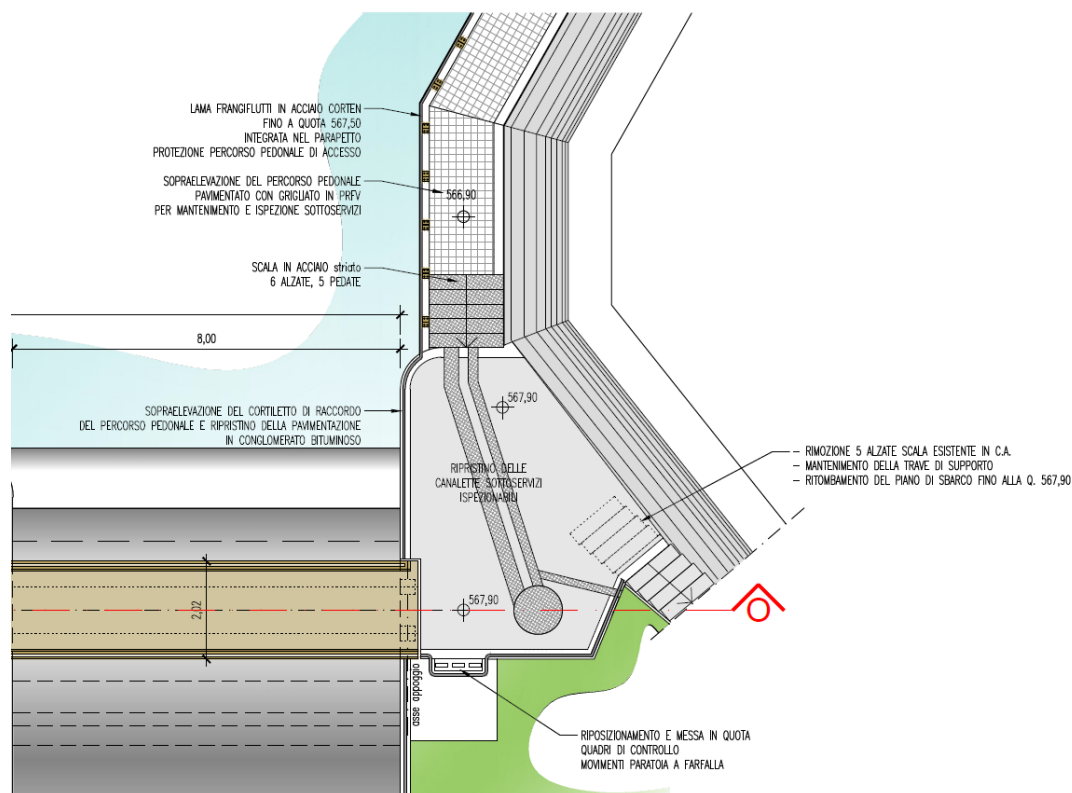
estratto dalla planimetria di progetto – particolare della spalla sinistra con scalette che verso valle portano al piazzale della casa di guardia e verso monte al camminamento che porta all'opera presa.
